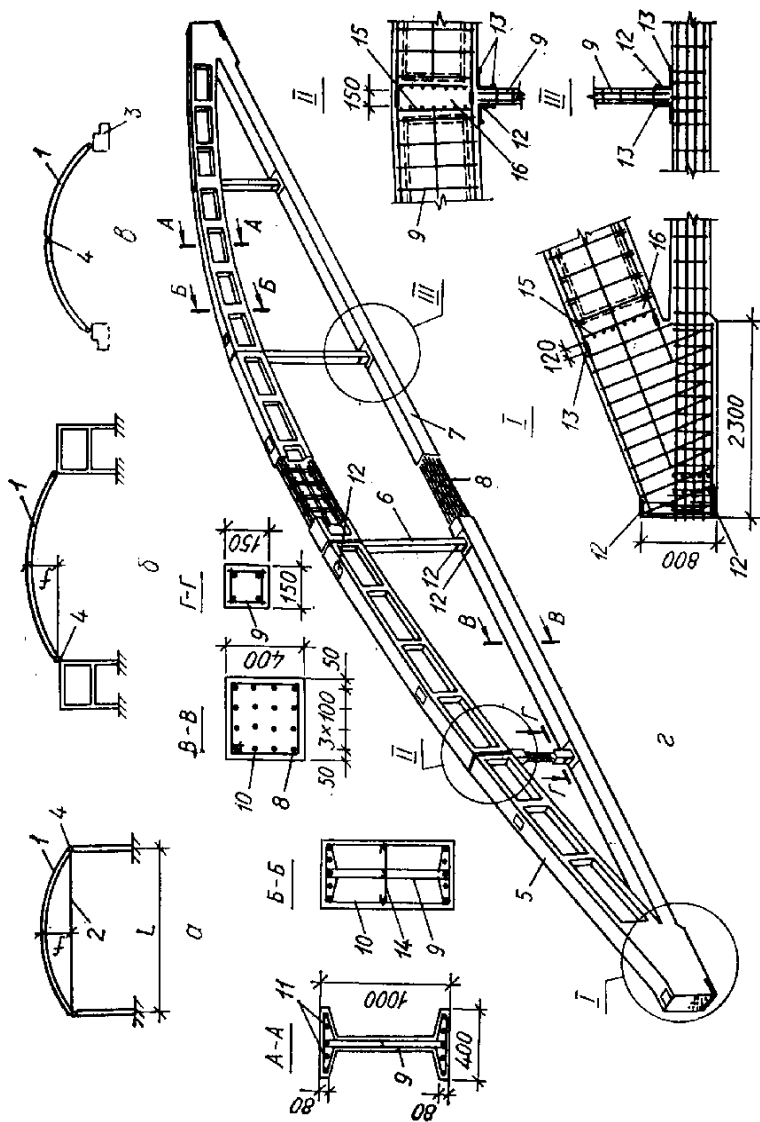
Залізобетонні арки: а – двошарнірна зі стяглем; б – те ж, без стягля; в – тришарнірна без стягля; г – конструювання збірної арки; 1 – арка; 2 – стягль; 3 – фундамент; 4 – шарнір; 5 – збірний елемент арки; 6 – почіпка; 7 – стягль; 8 – напружувана арматура; 9 – зварний каркас; 10 – хомути; 11 – стержні; 12 – закладна деталь; 13 – зварювання; 14 – шпилька; 15 – сітка; 16 – бетон замоноличування
